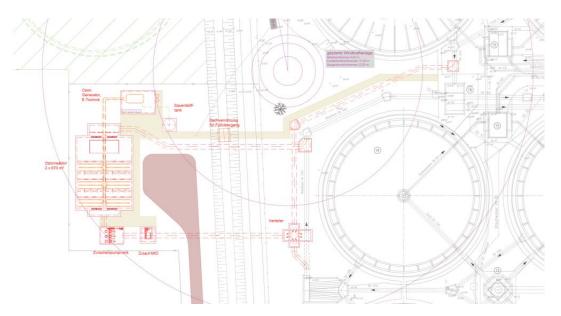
Lageplan Variante 3: Ozonierung
